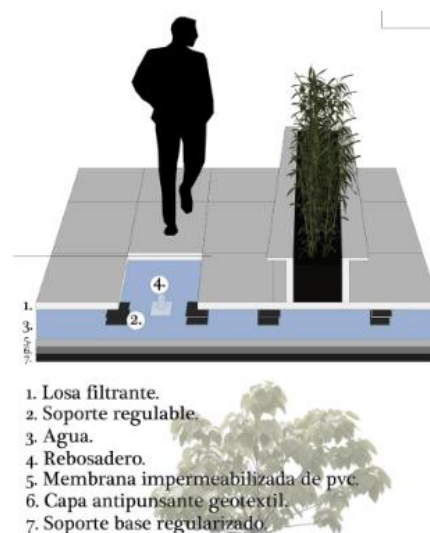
Detalle de cubierta. Fuente: autor (2017) CC: BY NC ND
